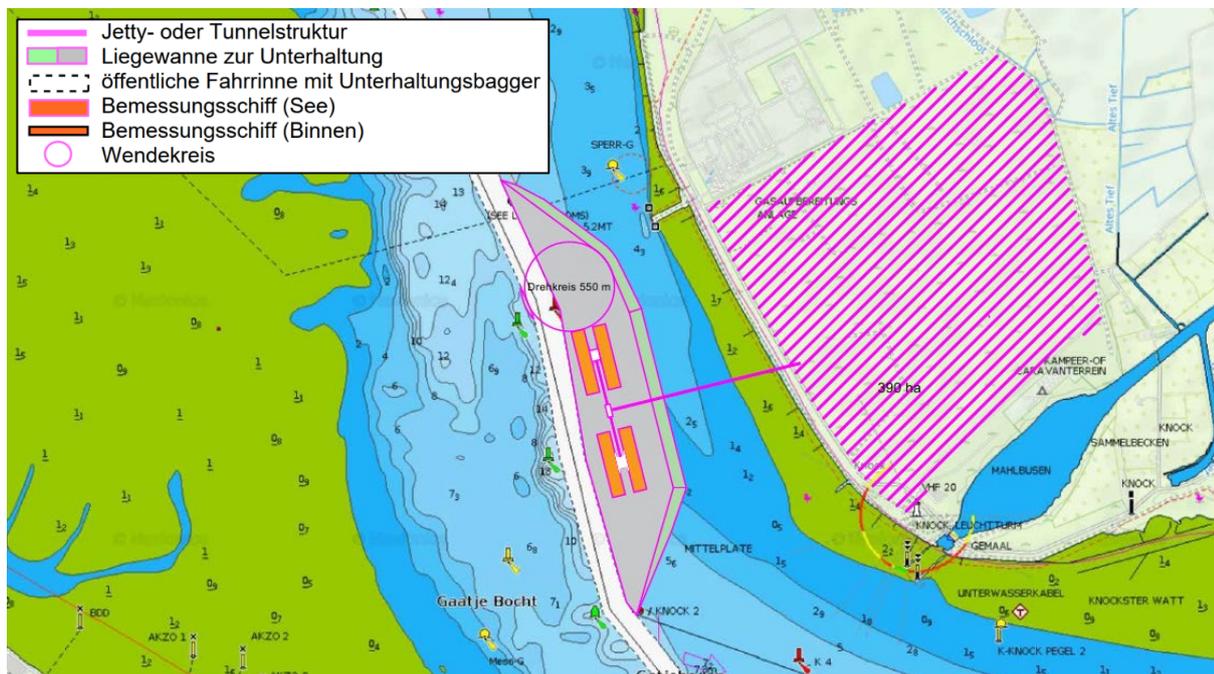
Lageplan Alternative 3: Emden (Rysumer Nacken)¹⁷⁷
